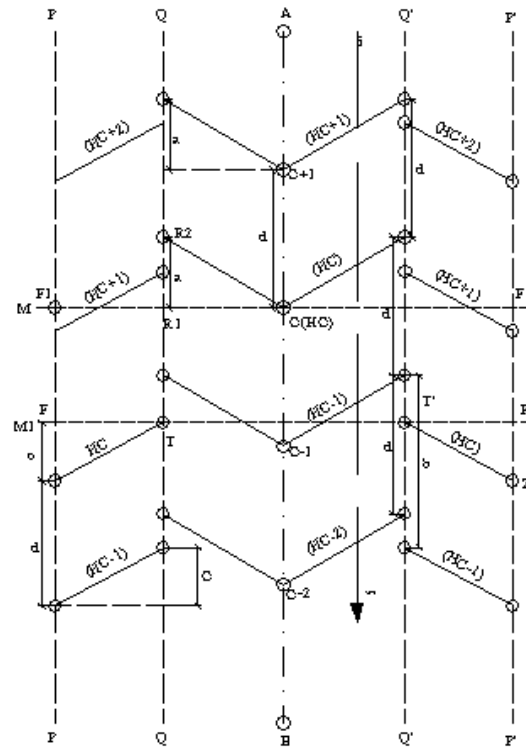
Plan de situație cu elementele sistematizării verticale
